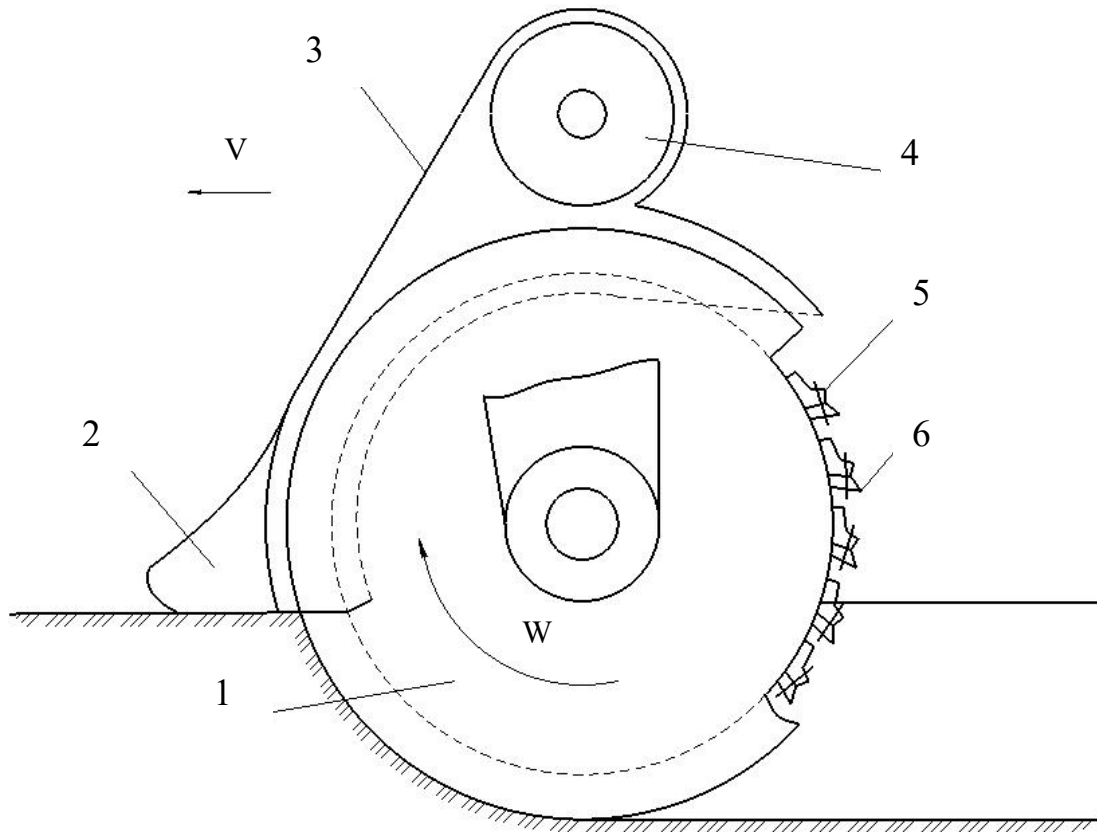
Схема дисковой фрезы: 1 – диск; 2 – отбойная плита;
